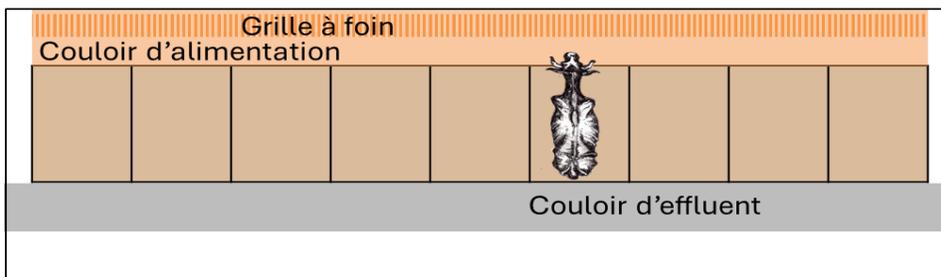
EXEMPLE D'UNE CONFIGURATION FACE AU MUR
